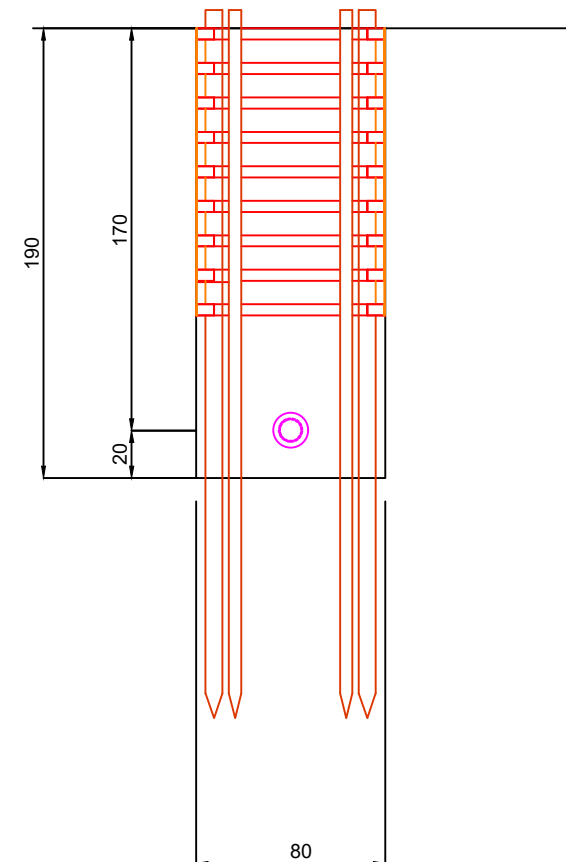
DETAIL PEMASANGAN TURAP PENAHAN TANAH PIPA CROSSING
